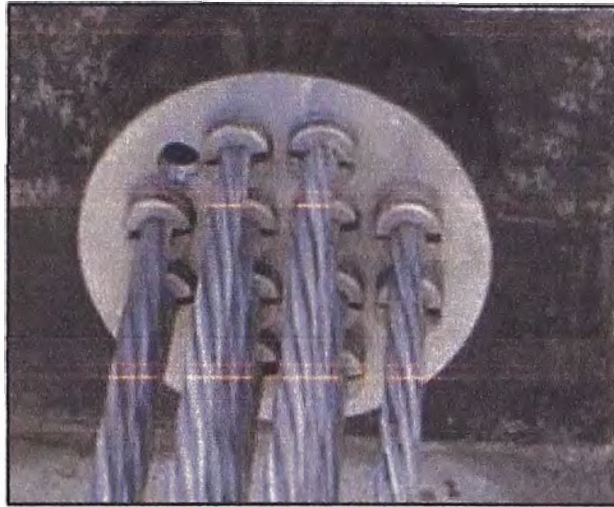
Placa de apoyo y cabeza de sostenimiento para tensado. Notar las cuñas en los cables
